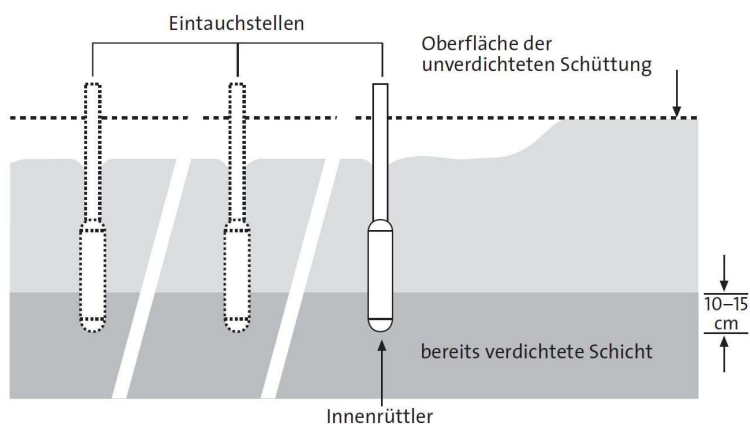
Vernadelung der einzelnen Betonlagen¹⁷³
